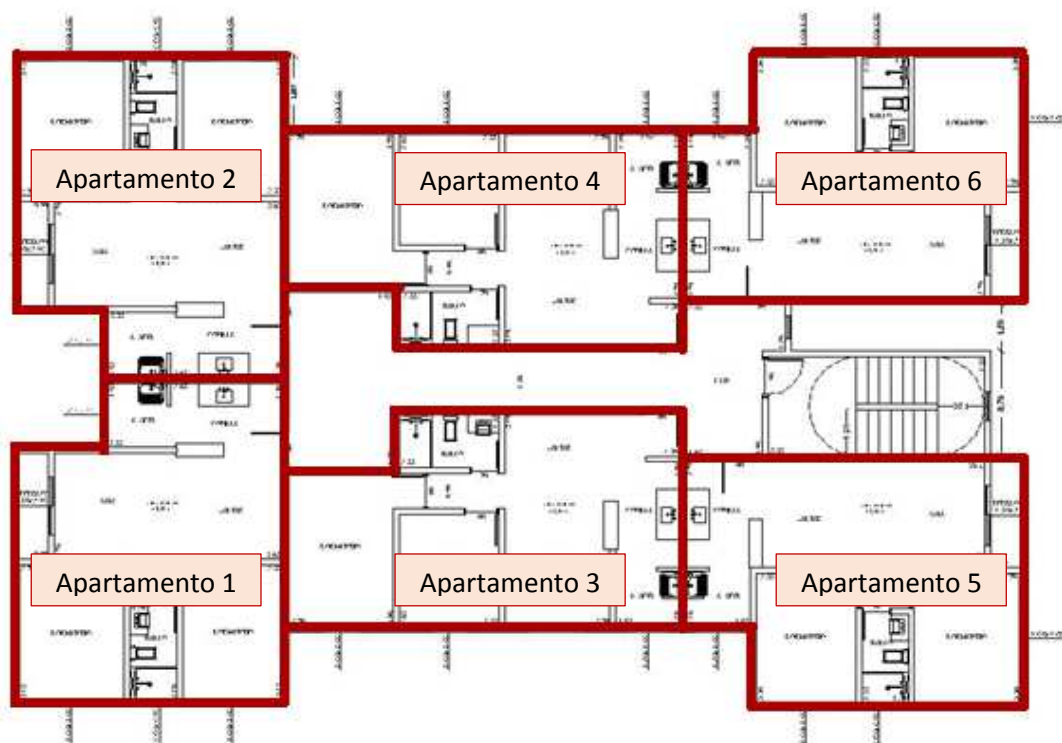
Divisão dos apartamentos na planta do pavimento tipo
